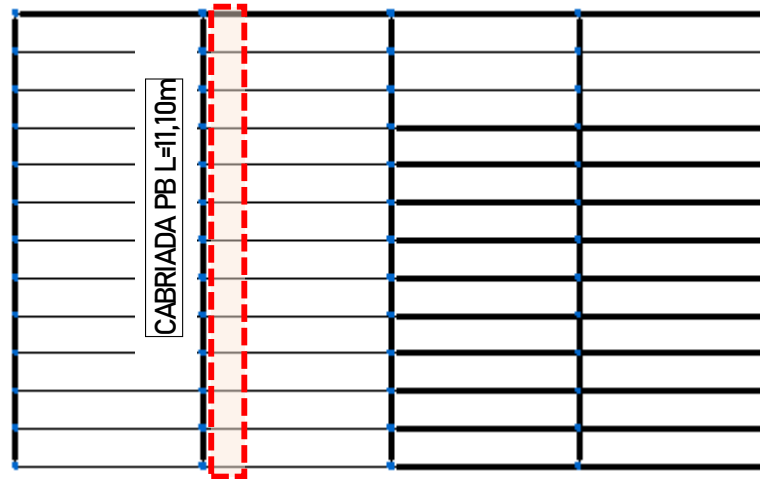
Geometría Modelo CYPE 3D – barras Planta de Techos Techo PB
